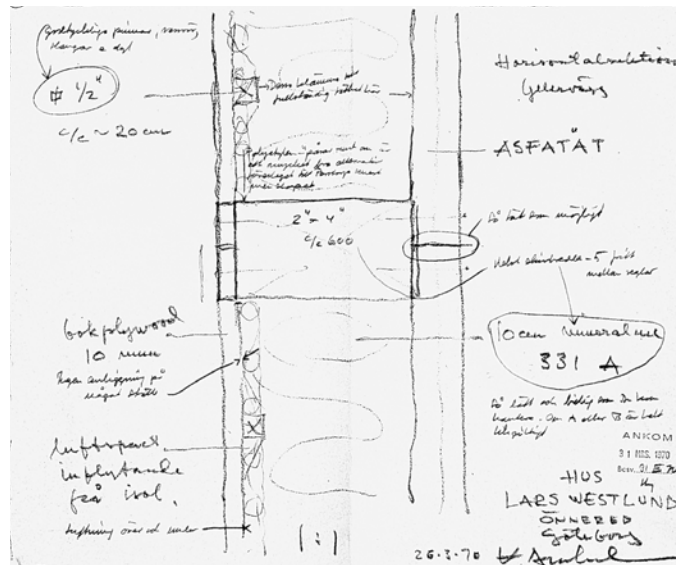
Villa Westlund. Detalle de fachada a mano alzada. 26 de marzo de 1970. El dibujo describe el sistema constructivo en un estado inicial. Para la fachada se piensa inicialmente en un tablero de contrachapado de haya. Al interior Anshelm mantiene el tablero de viruta de madera y asfalto, Asfatät, que había pensado para su propia casa, y con el que acababa de construir el estudio para Lewerentz en el jardín de la casa de Kävlingsvägen 26. Ver capítulo 4 y 5 de esta tesis.. Arkdes.
